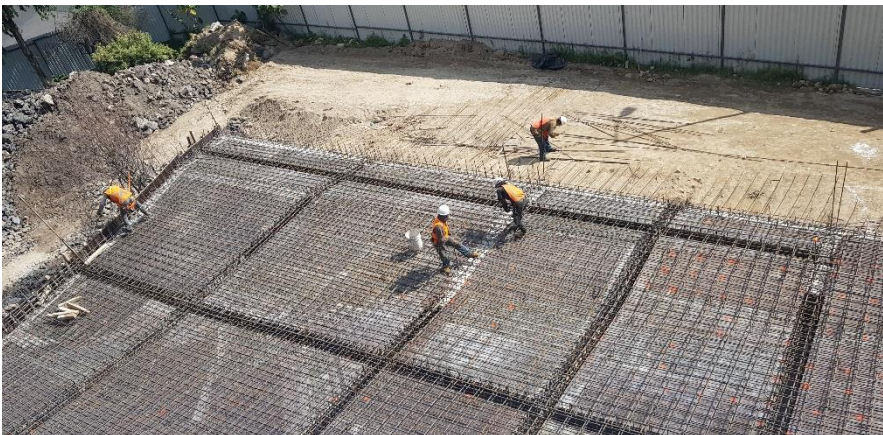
Fotografía del armado a dos parrillas de la losa tapa.
